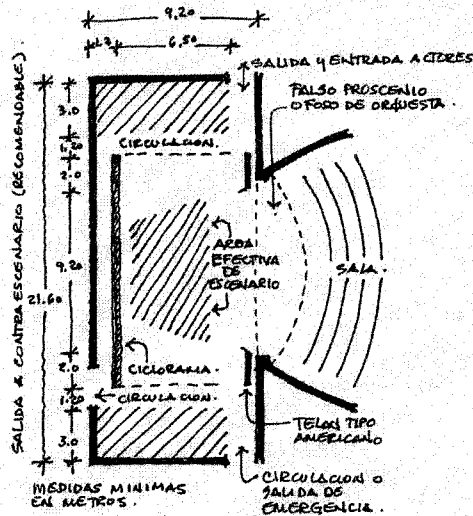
Planta con distancias Promedio recomendables en el escenario.
